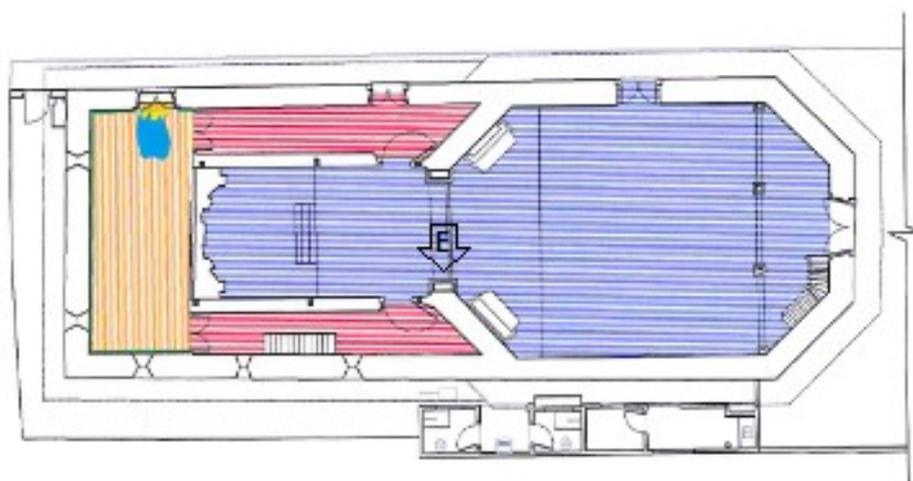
Vista E - Coluna e capitel do lado esquerdo do arco do cruzeiro – Planta pavimento inferior Capela Sem escala.
